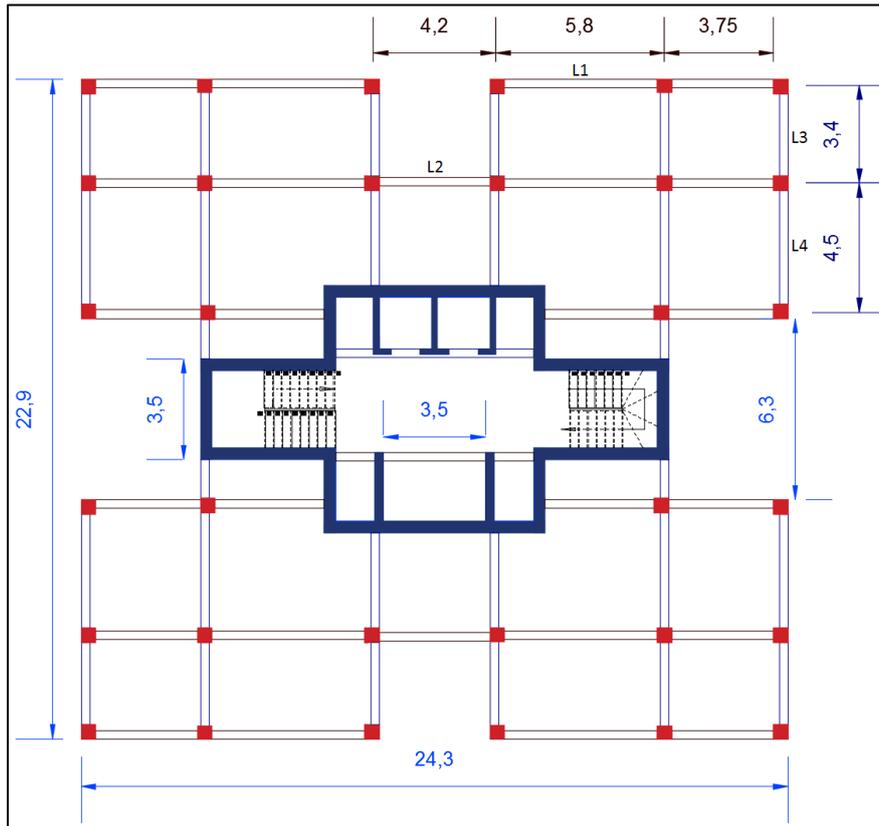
Vue en plan (Poteaux-Poutres)
